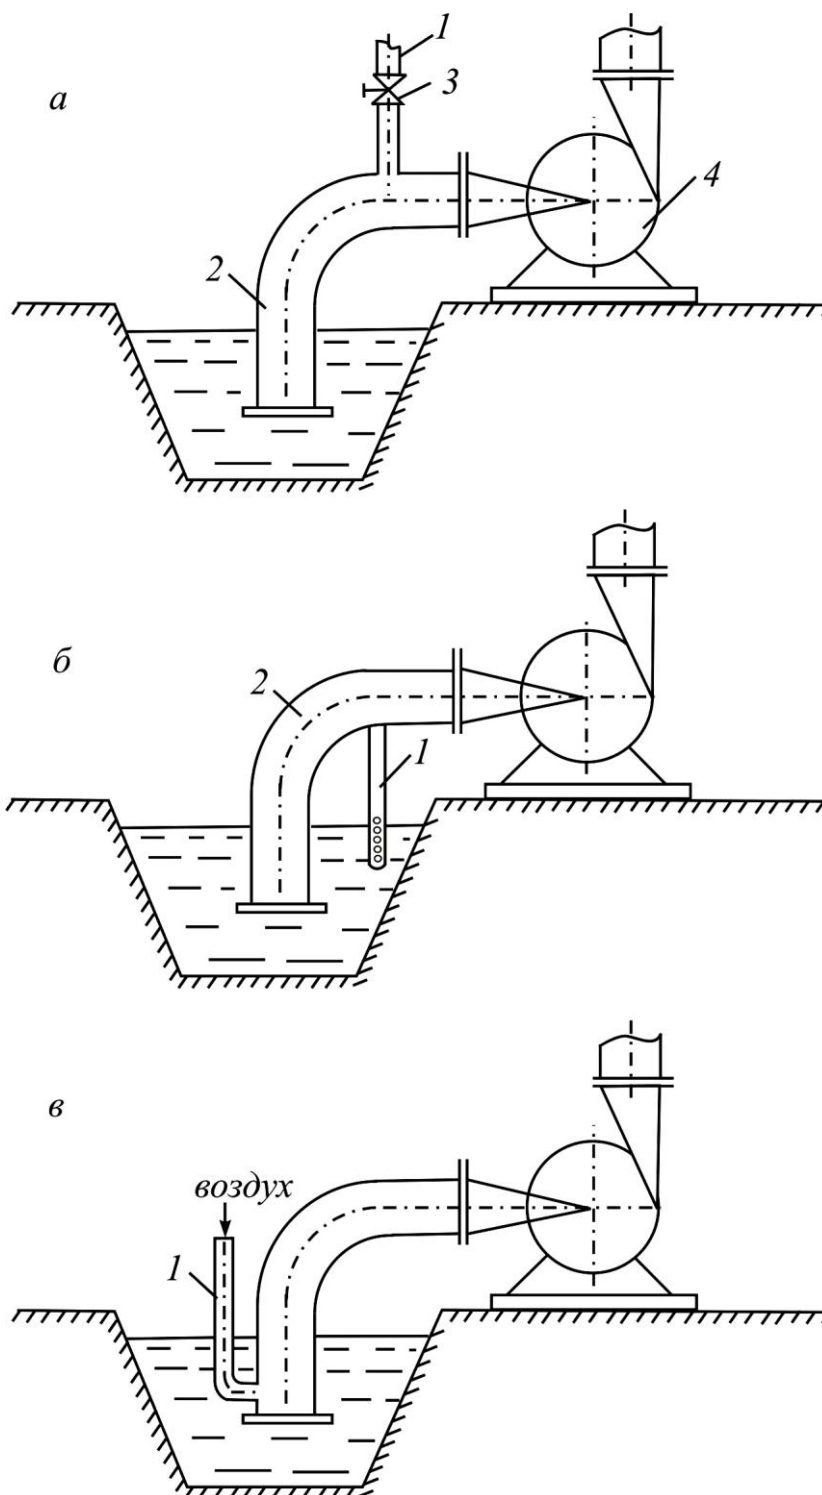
Принципиальные схемы подвода воздуха во всас насоса в период подрезки гидромониторного забоя: 1 – трубка для подвода воздуха; 2 – всасывающий трубопровод; 3 – кран; 4 – грунтовый насос
